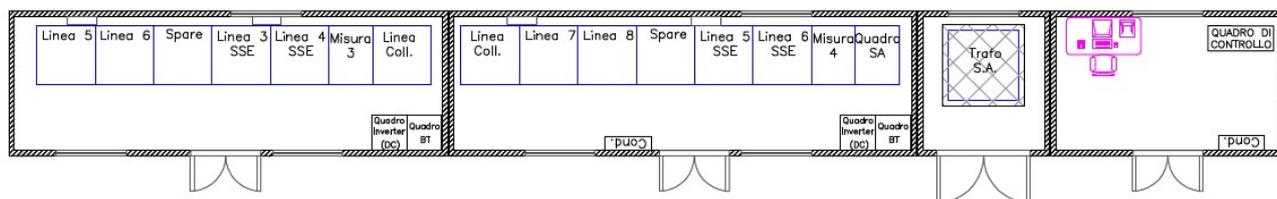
Quadro di Raccolta e Misura: Zona 2, Planimetria
